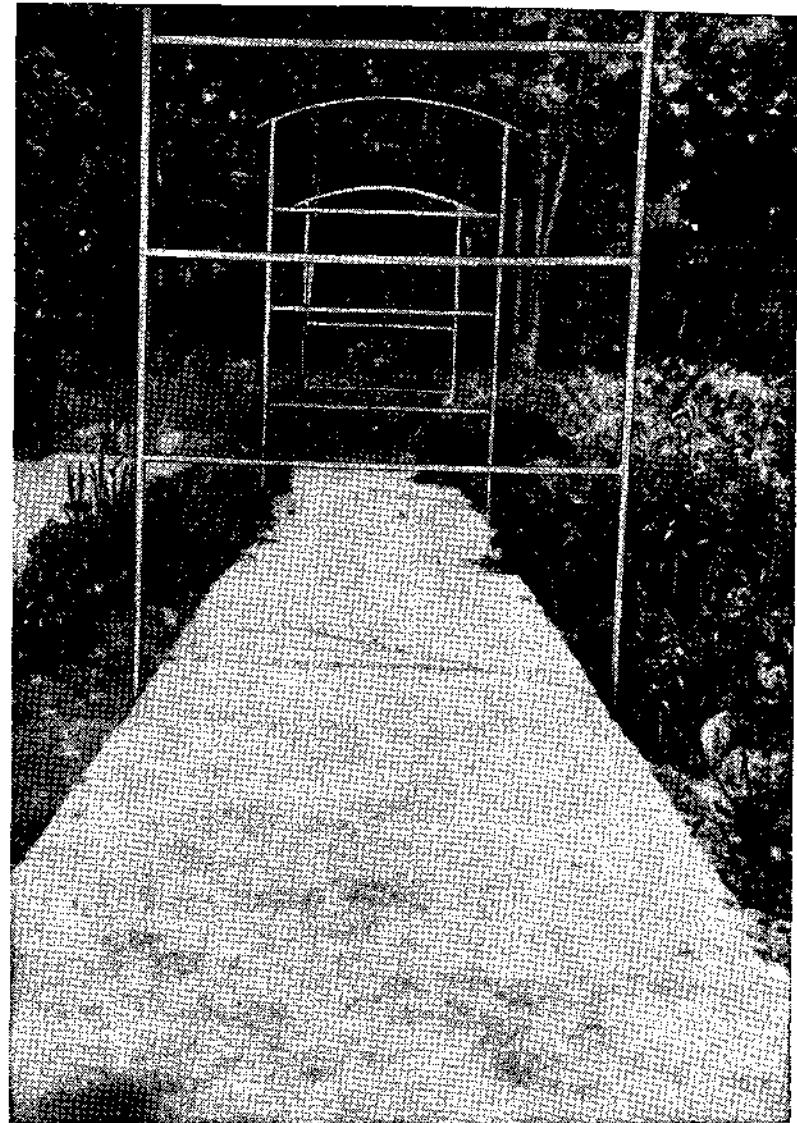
Деформационные швы в бетонном дне сделаны через каждые 3,75 м. Стены будут сооружены из грунто-цементных блоков.
